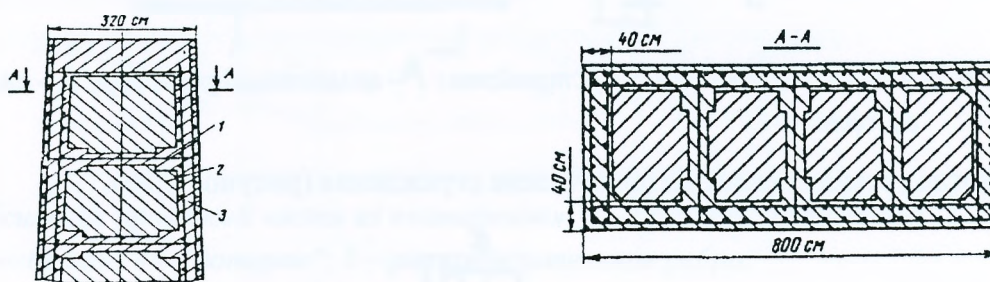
Усиление опоры железобетонной оболочкой: 1 – связи между стенками оболочки; 2 – кладка опоры; 3 – оболочка.
